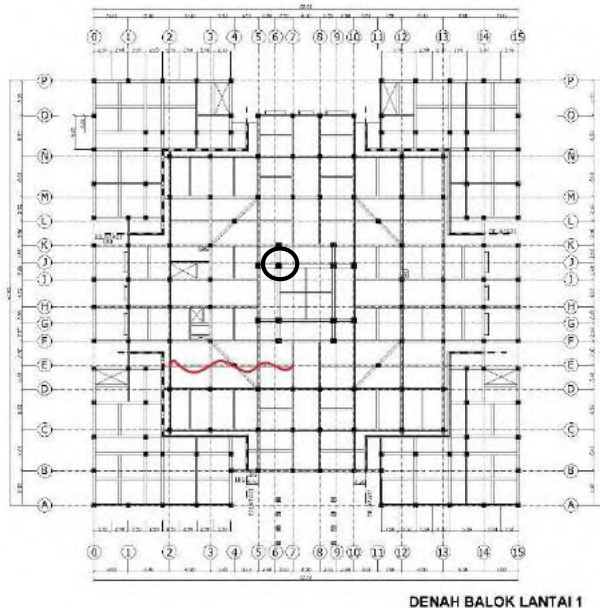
Analisa Hubungan Balok Kolom Eksterior
